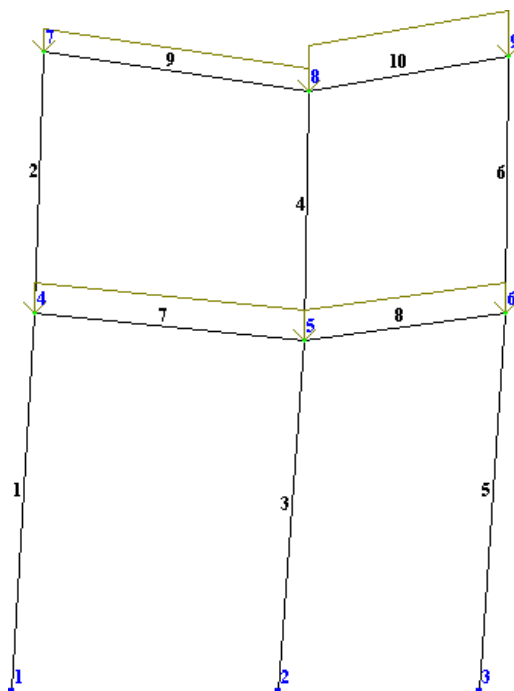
Расчетная схема с учетом перемещений узлов [Вывод на экран эпюр внутренних](#)
